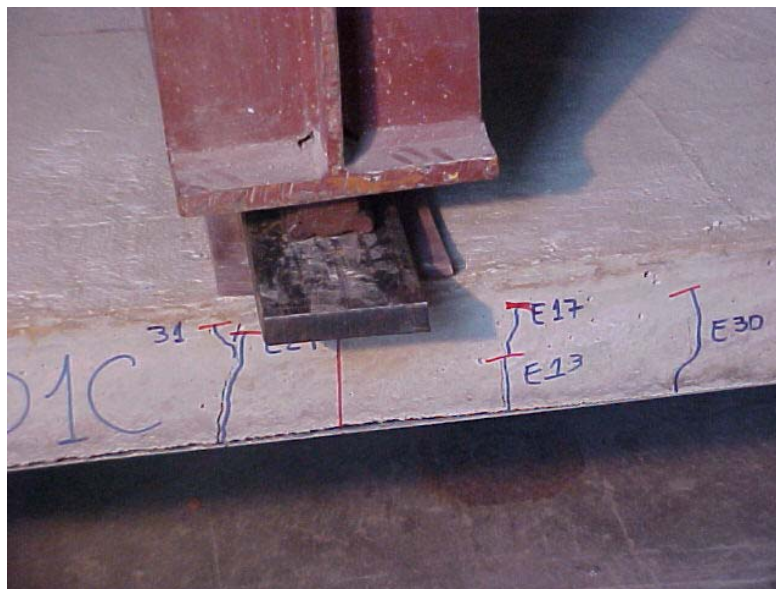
Ocorrência de fissuras simetricamente dispostas e igualmente espaçadas
